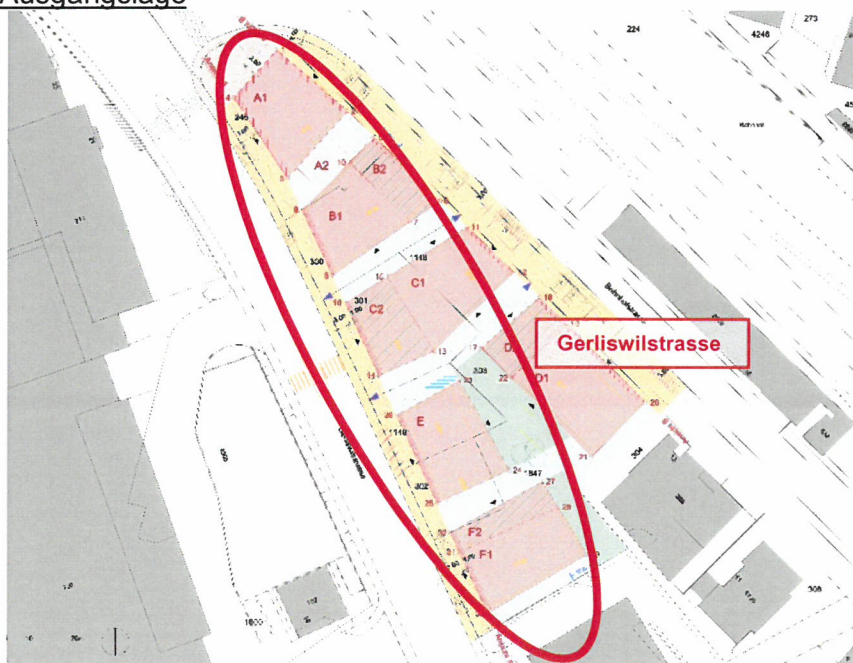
Ausschnitt Situation Bebauungsplan «Emmenbaum Nord» [01]
